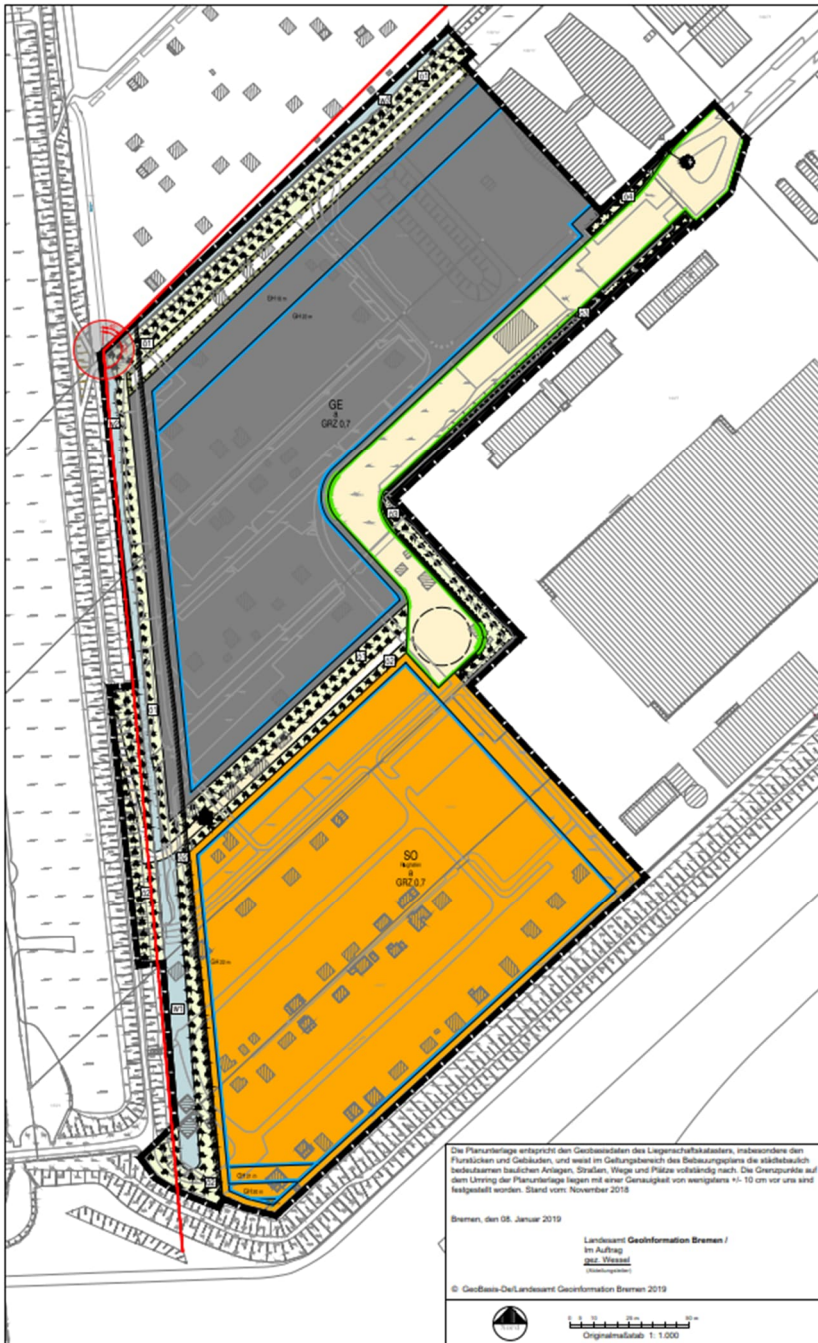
Darstellung des geplanten Bebauungsplans 2514
